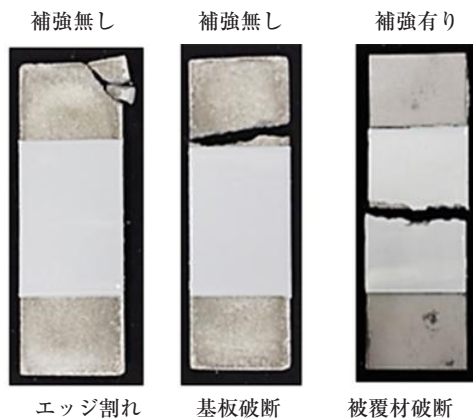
試験体の状況 エポキシ樹脂系 (基板 A)
